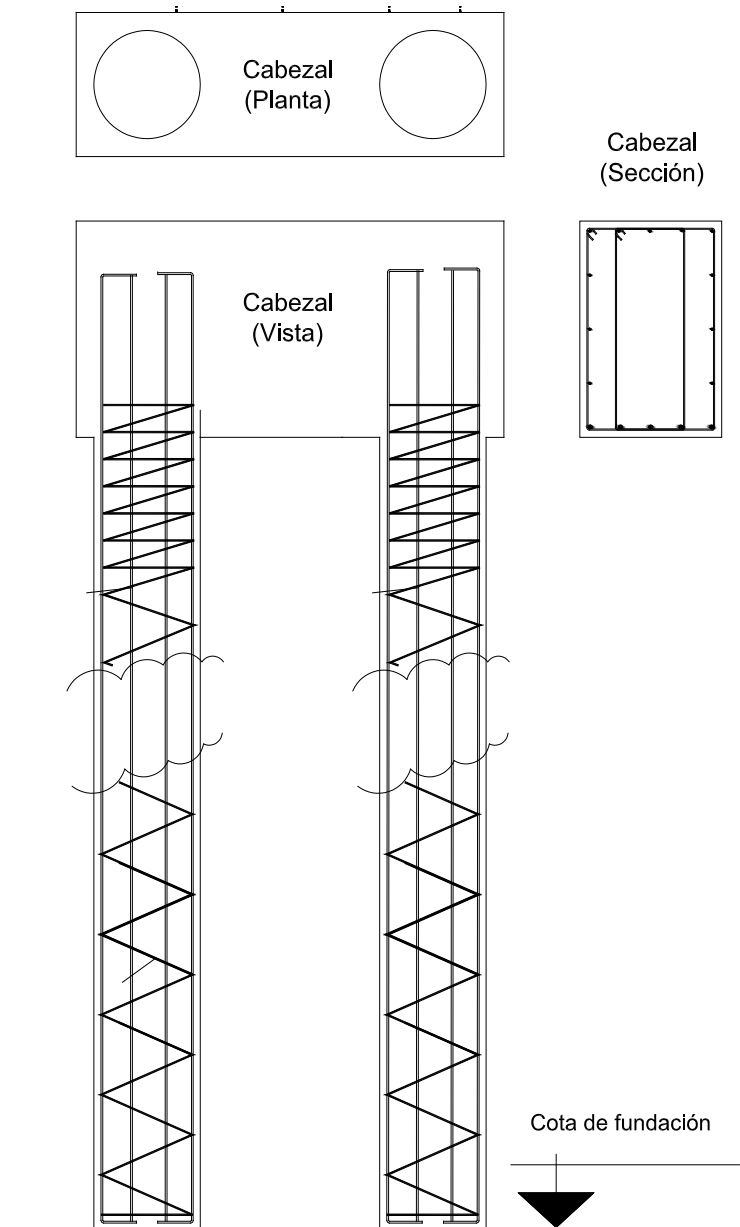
Plano típico de un grupo de dos pilotes y cabezal
